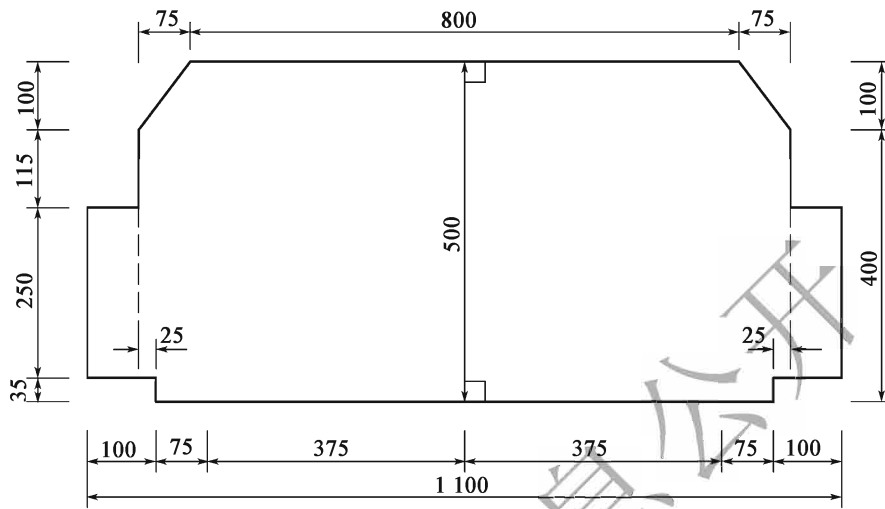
Dégagement de construction du tunnel routier de deuxième classe à deux voies(80km/h) (unité:cm)
